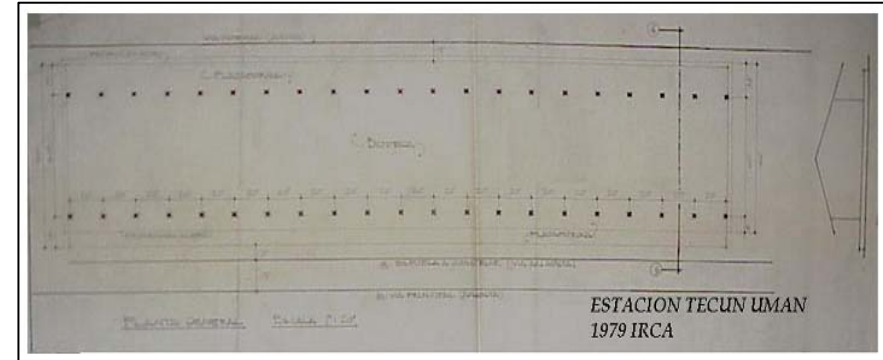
PLANTA ORIGINAL BODEGAS AYUTLA
